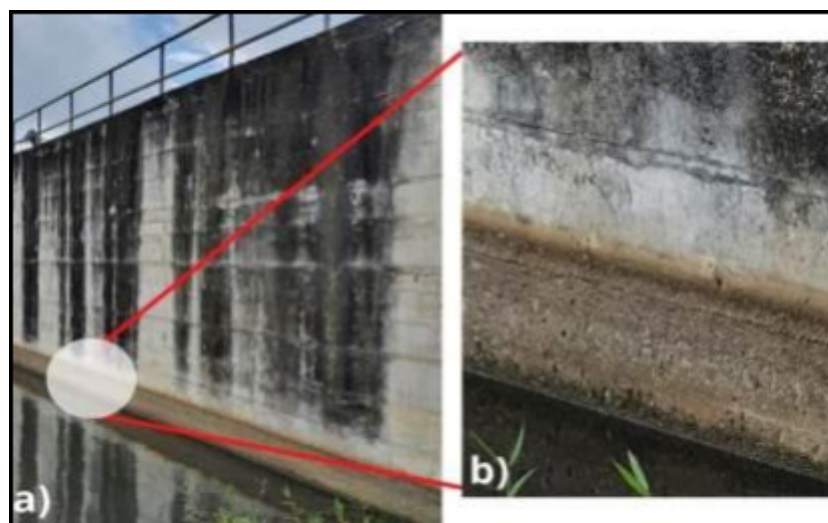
Paramento de montante apresenta manchas (a). Detalhes da deterioração (b).
